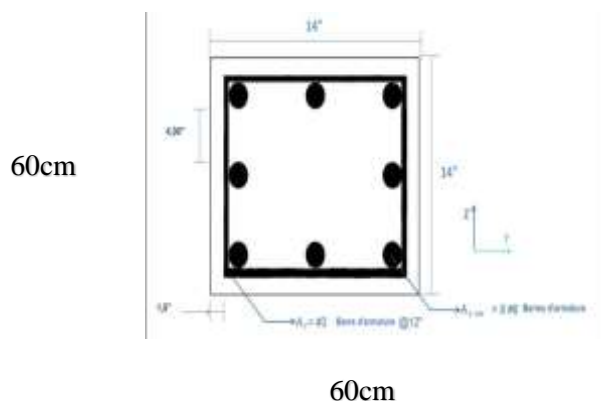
Exemple Schéma de ferrailage des poteaux
